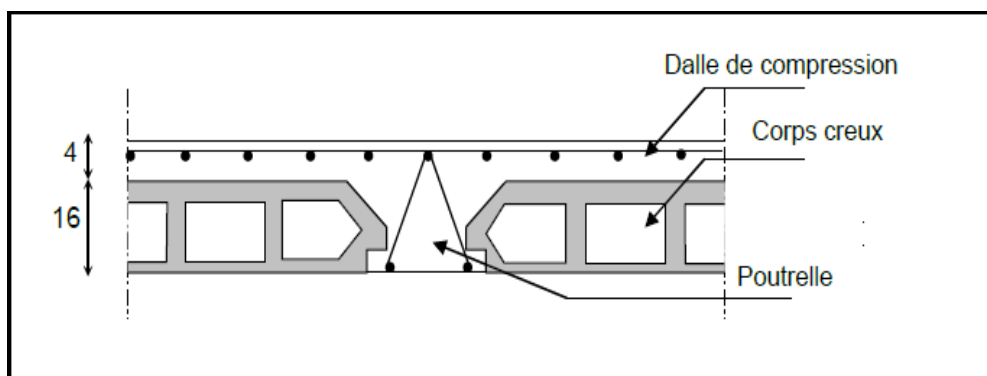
Coupe transversale d'un plancher à corps creux
